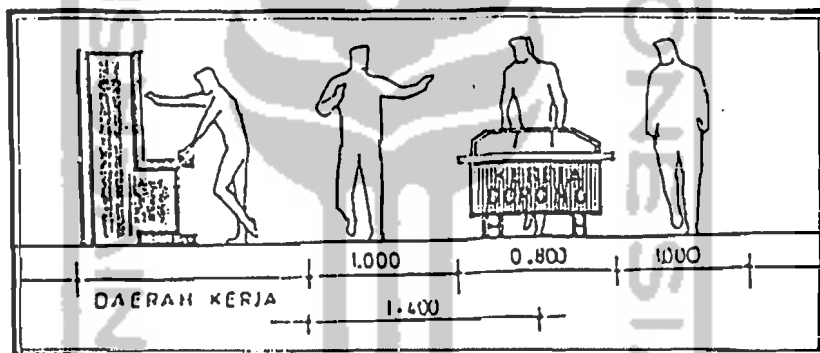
Kebutuhan ruang gerak berjalan membawa barang
